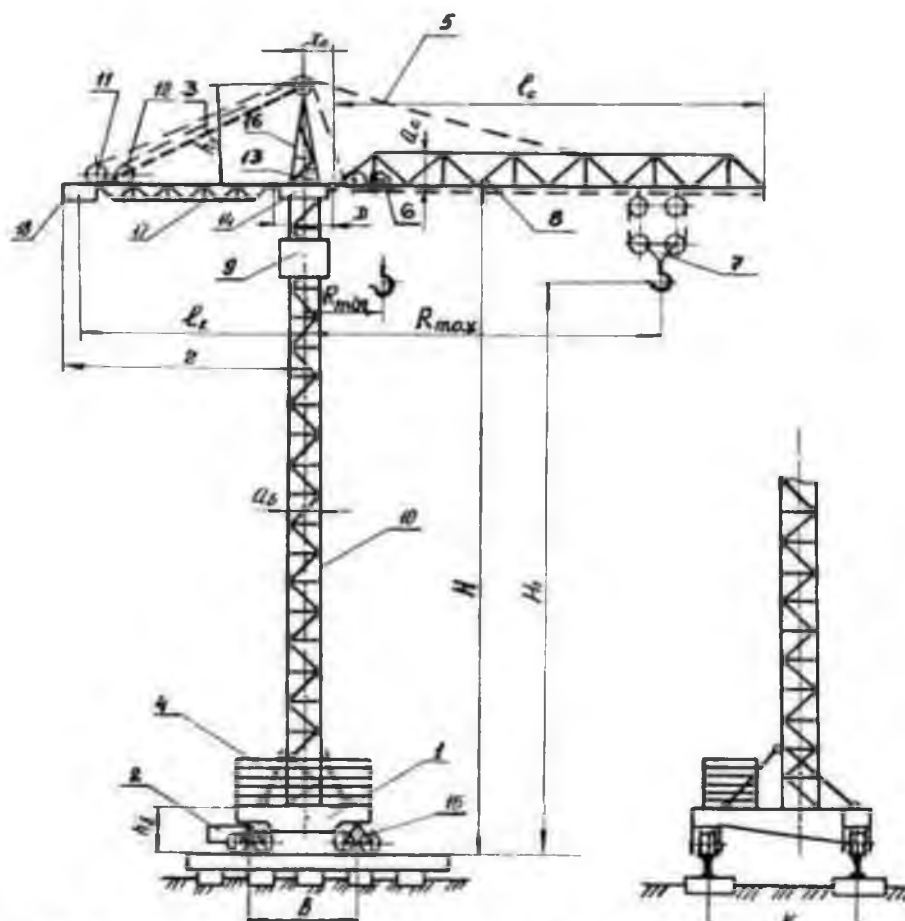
Схема баштового крана з неповоротною вежею: 1 - ходова рама; 2, 15 - ходові візки; 3 - розтяжка; 4 - баласт; 5 - стріловий розчал; 6 - тягова лебідка; 7 - гакова підвіска; 8 - стріла; 9 - кабіна; 10 - вежа; 11 - стрілова лебідка; 12 - вантажна лебідка; 13 - лебідка повороту стріли; 14 - опорно-поворотний пристрій; 16 - поворотний оголовок; 17 - протизага консолю; 18 - протизага
